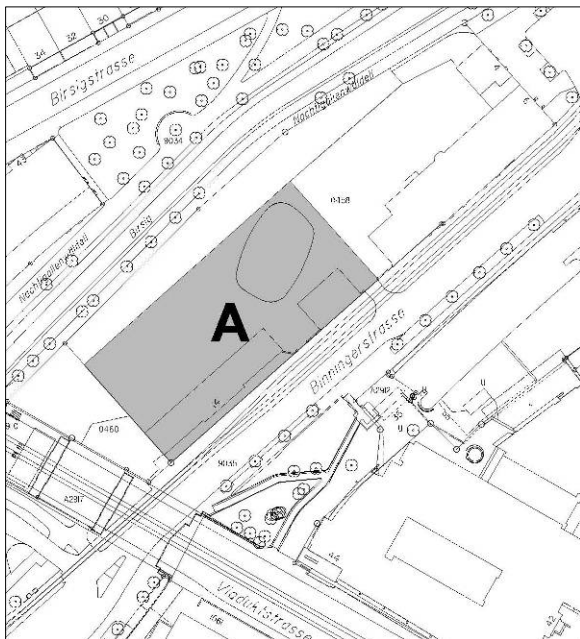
Entwidmung Kuppel, Acqua, Annex, Plan Nr. 13'432. (Kein Massstab, Plan genordet)
